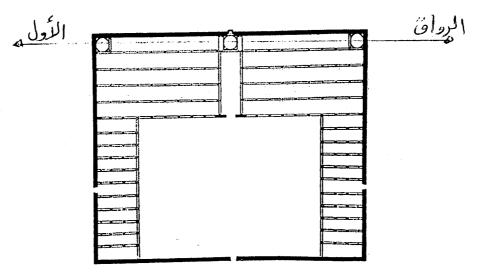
مسقط أفقي لمسجد آق سنقر المعروف بالجامع الأزرق بالقاهرة . (عن سامي عبد الحليم).
